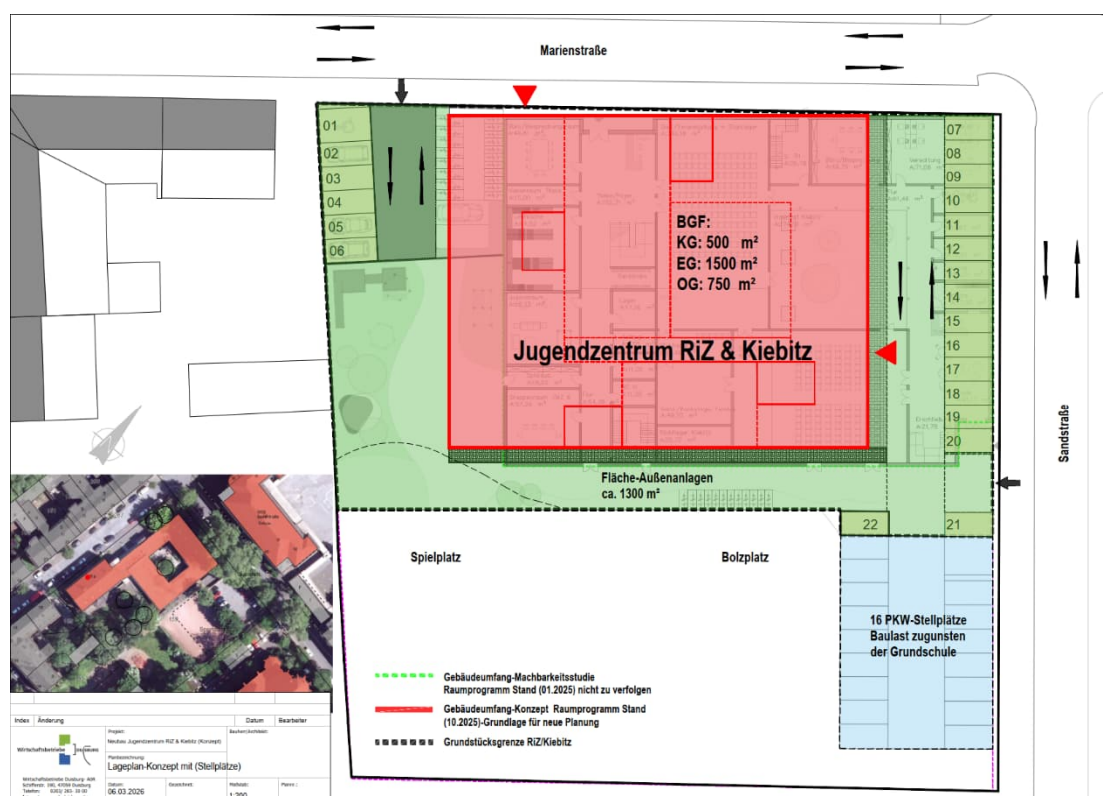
Lageplan mit Außenflächen (Freianlagen)
